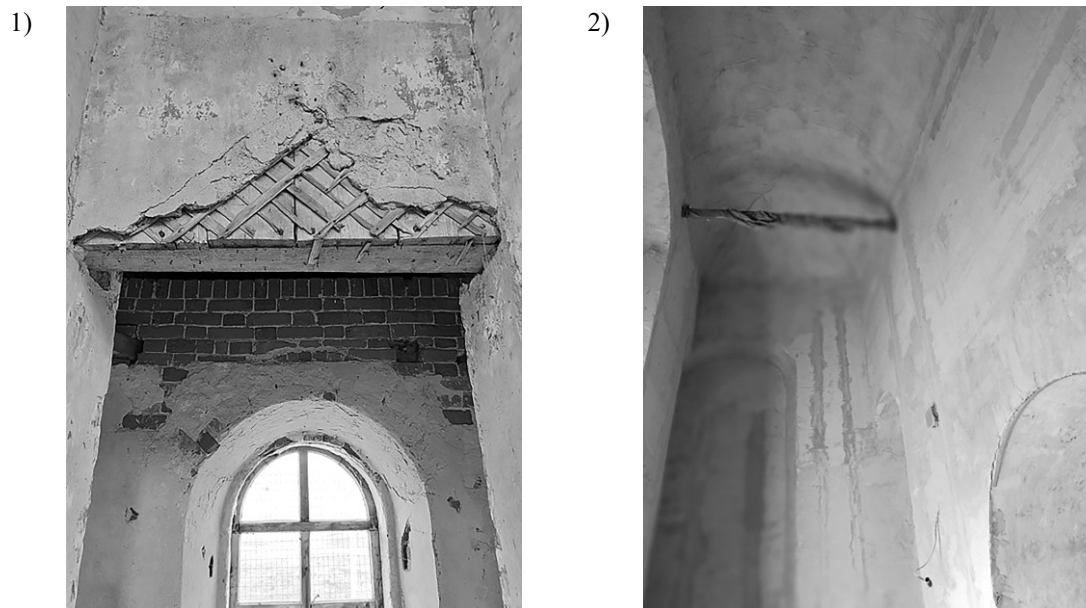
Церковь Николая Чудотворца: 1 – сохранившаяся историческая штукатурка; 2 – стены и свод в южном приделе – помещение № 5 по плану после нанесения штукатурки Baumit KlimaWhite (иллюстрация авторов)
